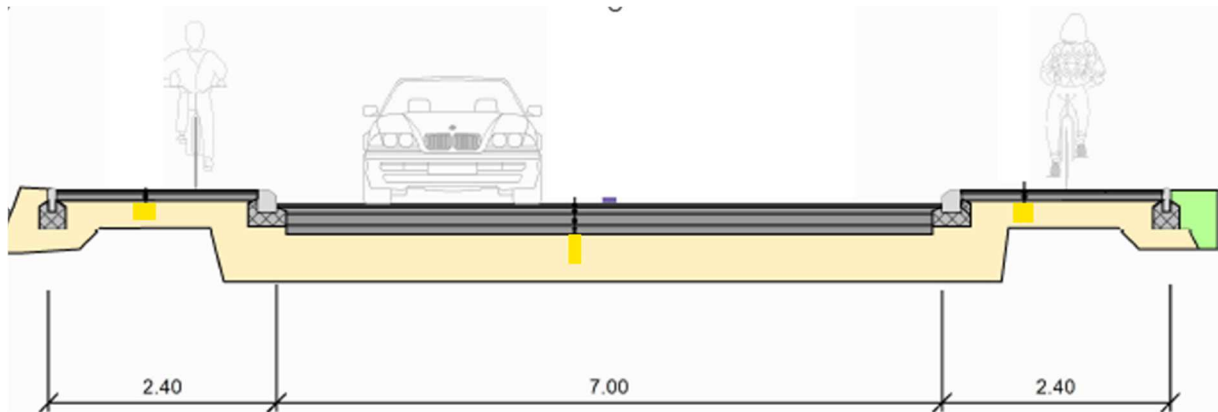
Profil type de la requalification de la RC 1 avec pistes cyclables
